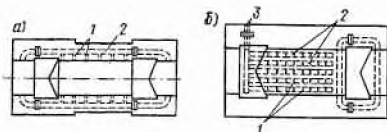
Схематические планы шлюзов с продольными водопроводными галереями
